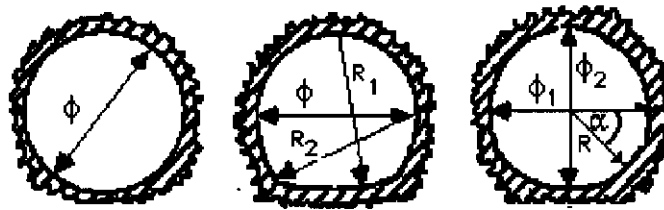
Diversas secciones transversales de túneles.
